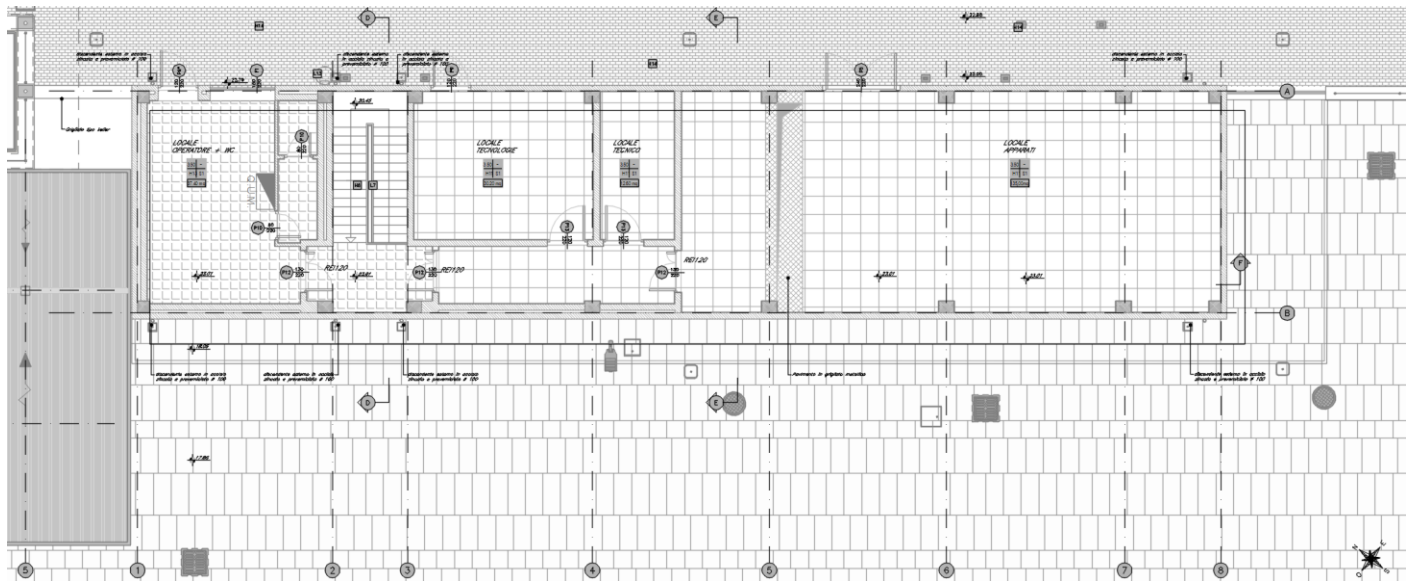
Stralcio pianta fabbricato tecnologico – piano primo
